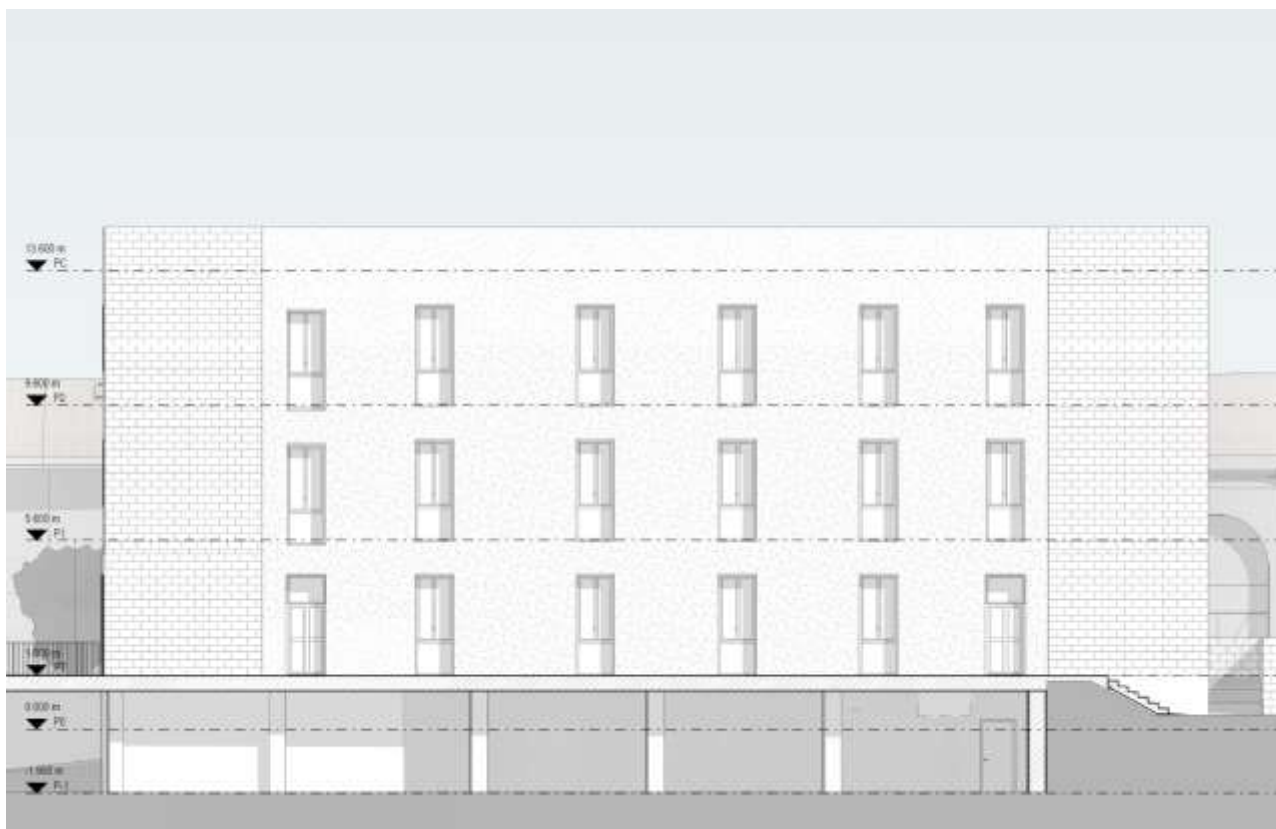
prospetto lato Caserma Gori (prospetto sud-est)
